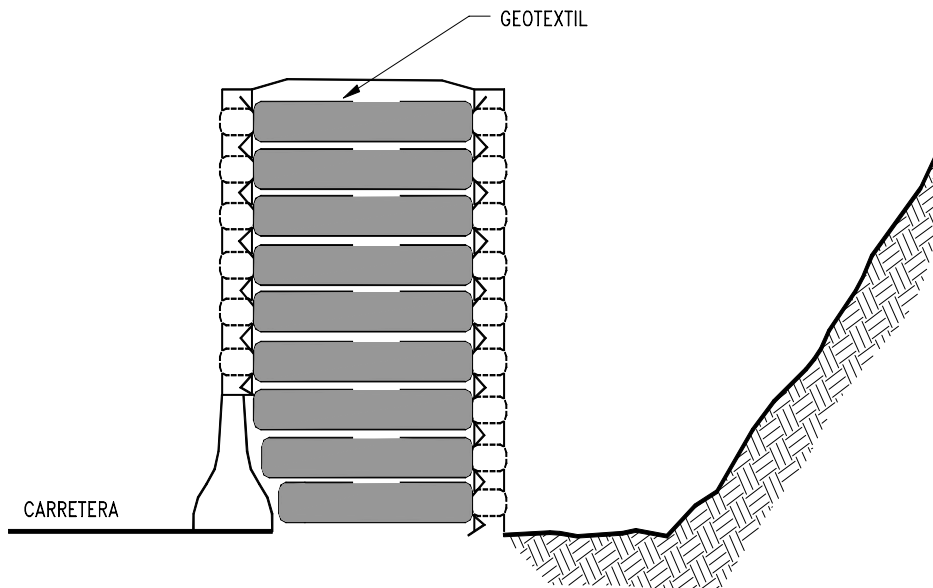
Barreras de tierra armada con geotextil para protección contra caídos y avalanchas.
